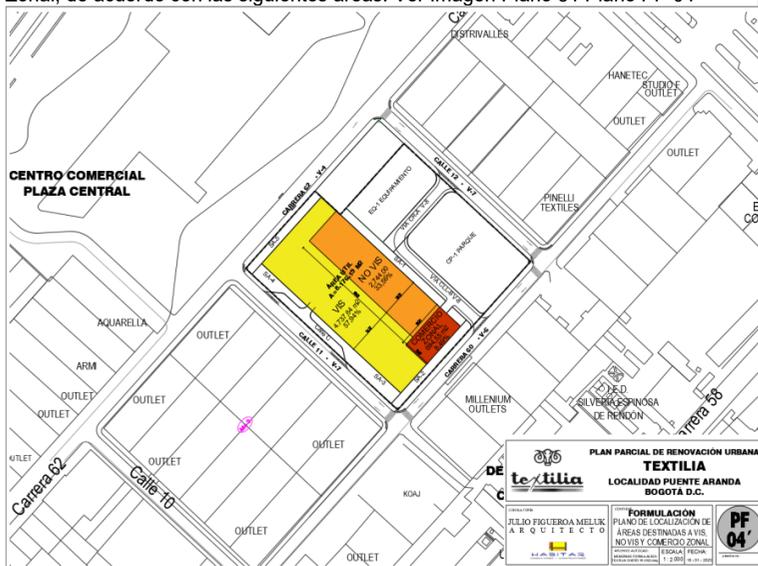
Plano PF-04' Áreas destinadas a VIS, no VIS y comercio zonal
